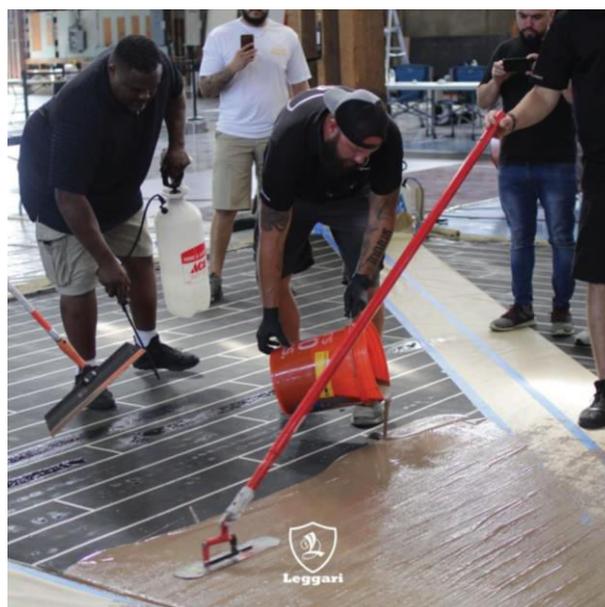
Aplicação de um pavimento epóxi com uma palustra [8]
